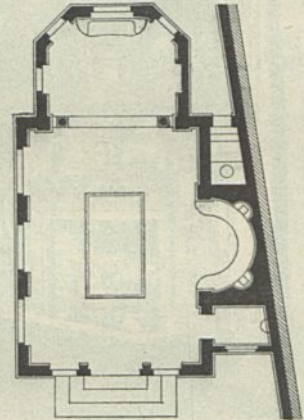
<sup>124)</sup> giebt den Grundriss des Billardzimmers in einem englischen Landhause. Es bildet die äußerste Ecke des Hauses und ist von einem Flurgange aus unmittelbar zugänglich. Neben dem Zimmer sind ein Wafchraum und ein Spilabot untergebracht.
